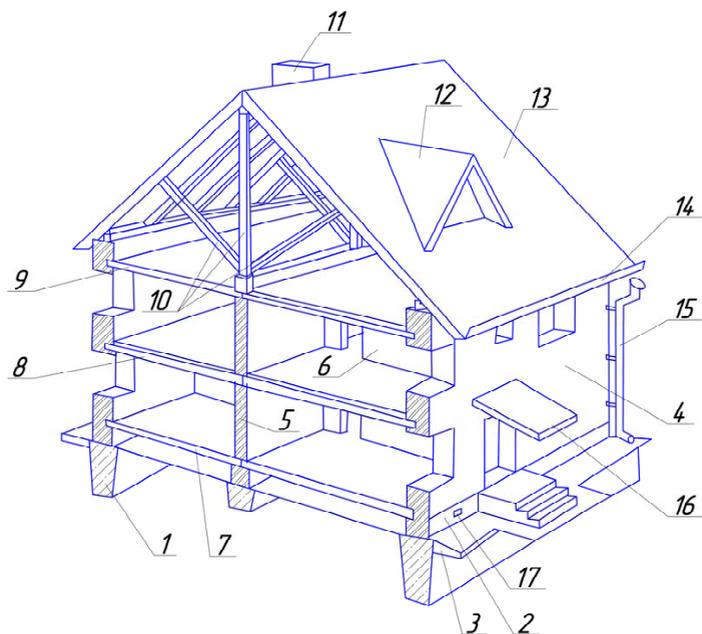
Пространственно-конструктивные элементы малоэтажного жилого дома: 1 – фундамент; 2 – цоколь; 3 – отсостка; 4 – наружная несущая стена; 5 – внутренняя несущая стена; 6 – перегородка; 7 – цокольное перекрытие; 8 – междуэтажное перекрытие; 9 – чердачное перекрытие; 10 – стойка и подкосы наклонных стропил крыши; 11 – вентиляционный канал; 12 – слуховое окно; 13 – скат кровли; 14 – водоотводные лотки; 15 – водосточная труба; 16 – навес над крыльцом; 17 – продух в цоколе
